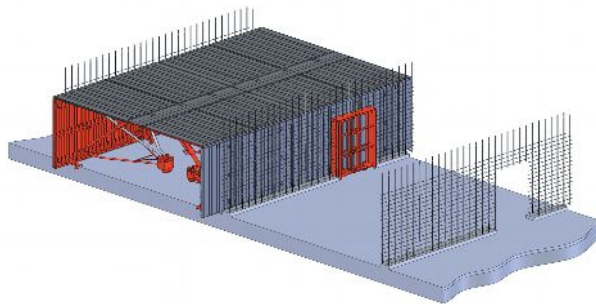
Betonarme perdelerine hasır çelik ve demir donatıları bağlanır.
